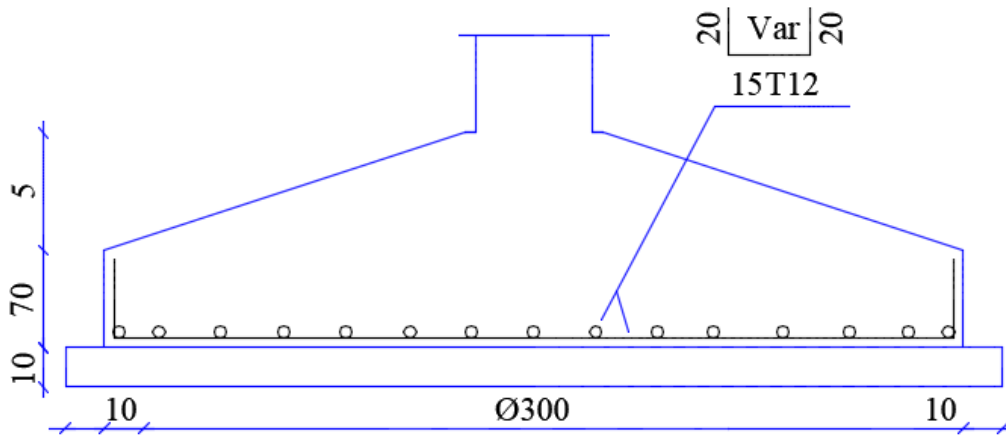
Ferrailage Le semelle circulaires isolées sous poteau
